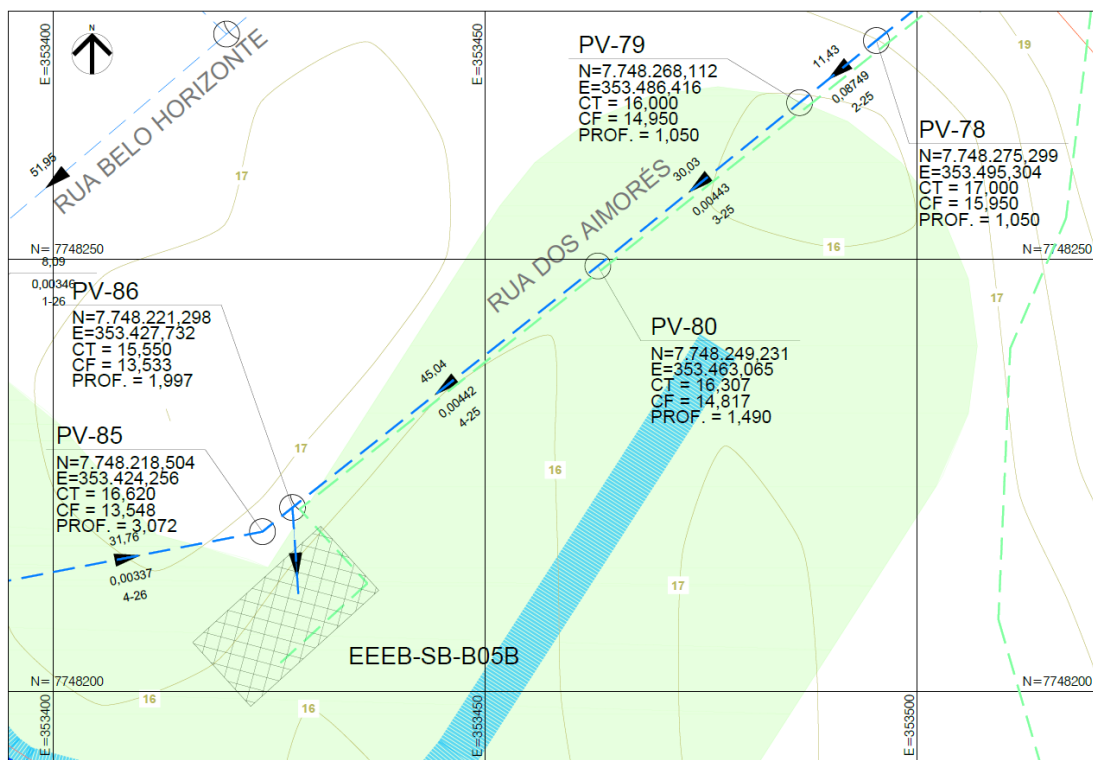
Estação elevatória de esgoto bruto EEEB-SB-B05B, em área de APP.
